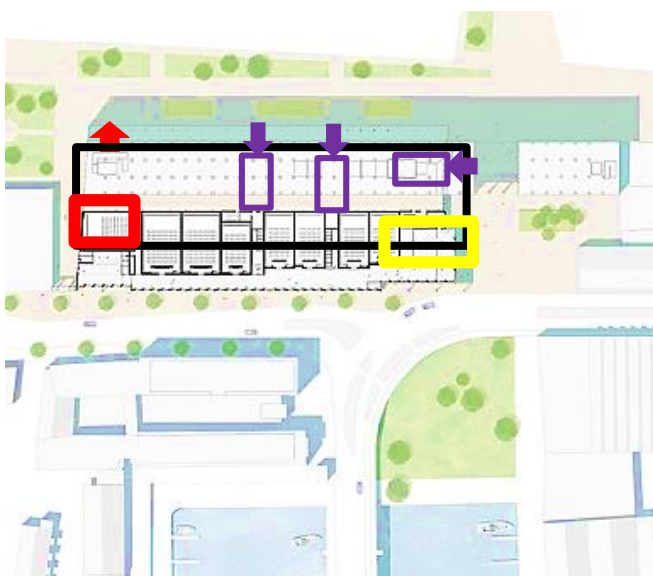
Plan d'étage Théâtre de Maastricht Pathé
